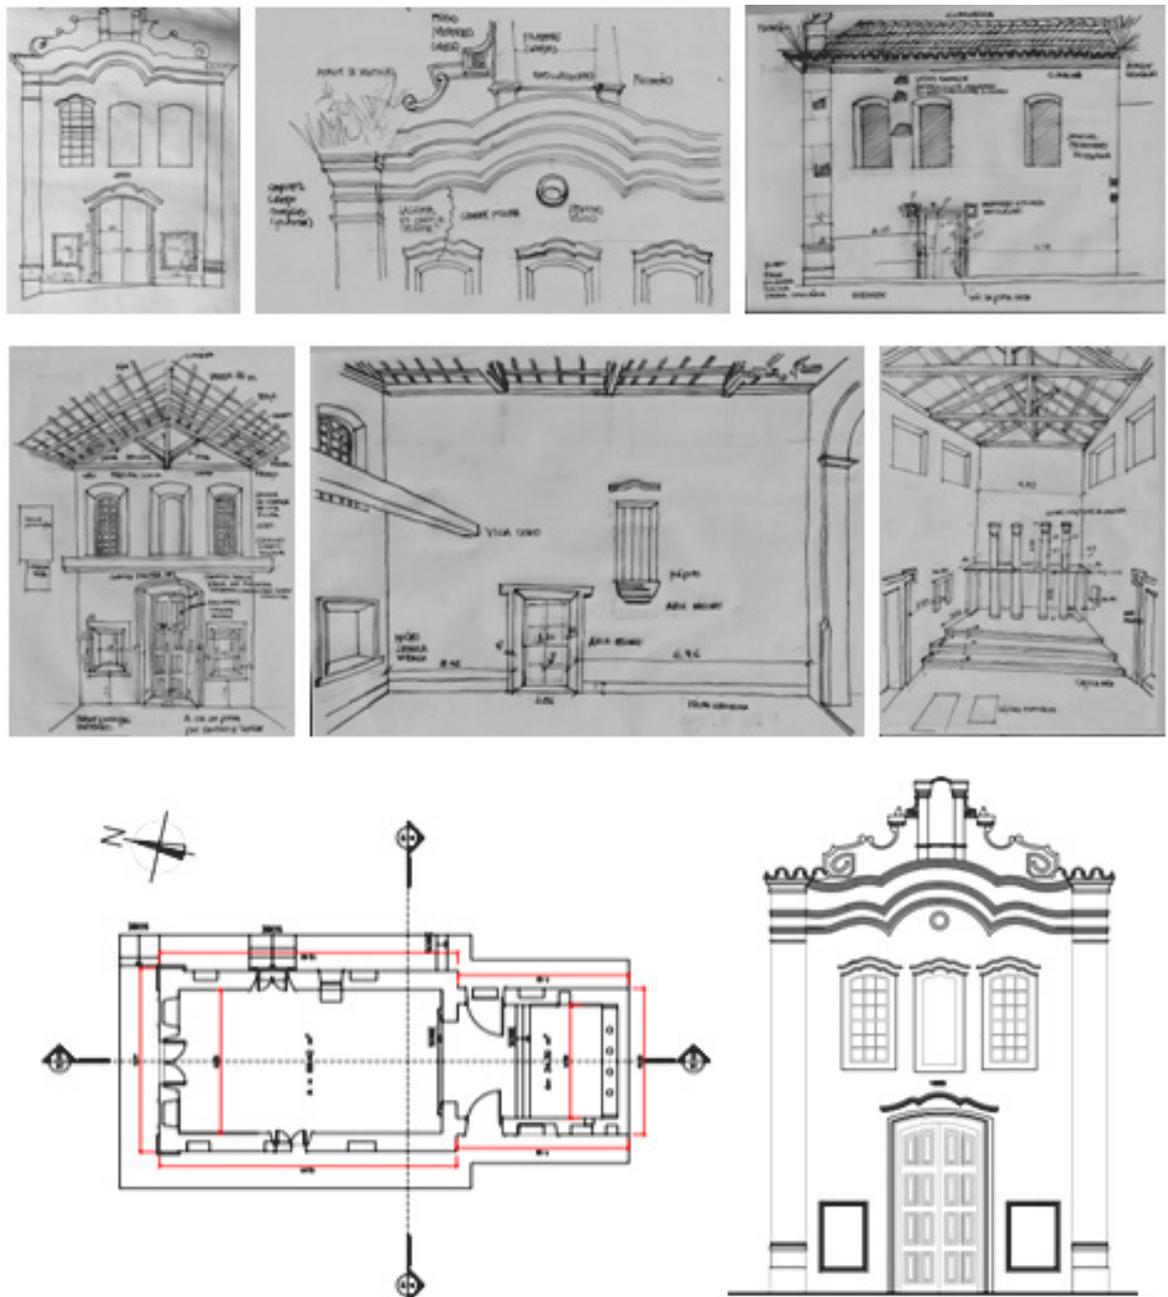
(Acima) – Esquerda: Croqui estudo “*in situ*” da fachada principal. Centro: Croqui estudo da platibanda. Direita: Croqui estudo da fachada nordeste. (Centro) – Esquerda: Croqui estudo parte interna fachada principal. Centro: Croqui estudo fachada lateral esquerda interna. Direita: Croqui estudo capela-mor. Desenhos: Eder Donizeti, jul. 2016. (Abaixo) – Esquerda: Planta baixa, esc. 1:50. Direita: Fachada principal, esc. 1:50. Desenhos: Luana Oliveira, ago. 2016.
